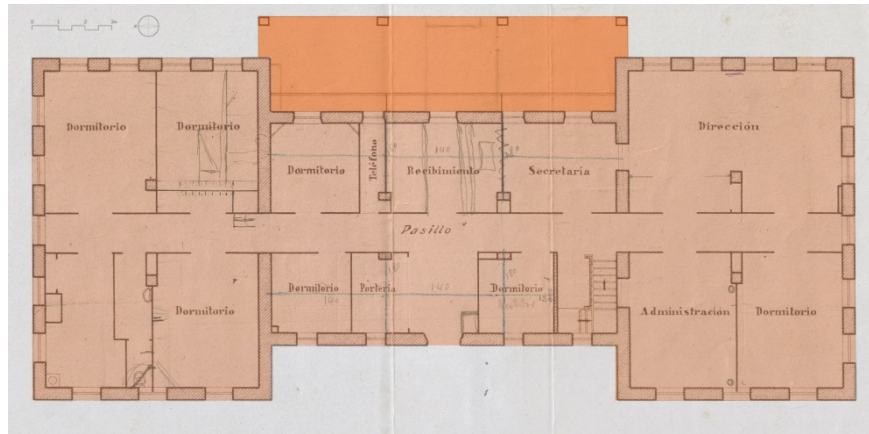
Ampliación comedor en planta baja y terraza. Fase 3. Pabellón de Administración y Hospedería. 1932-1969.
